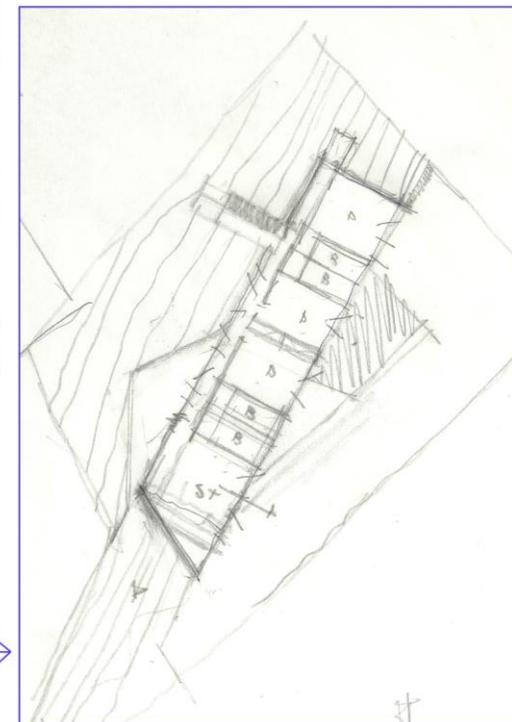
Desenhos em planta e corte elucidativos do projeto.
